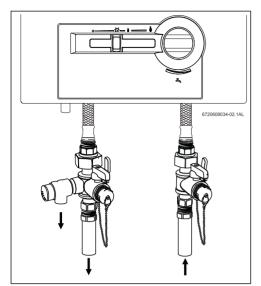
Raccordement des conduites et de la soupape de sûreté
